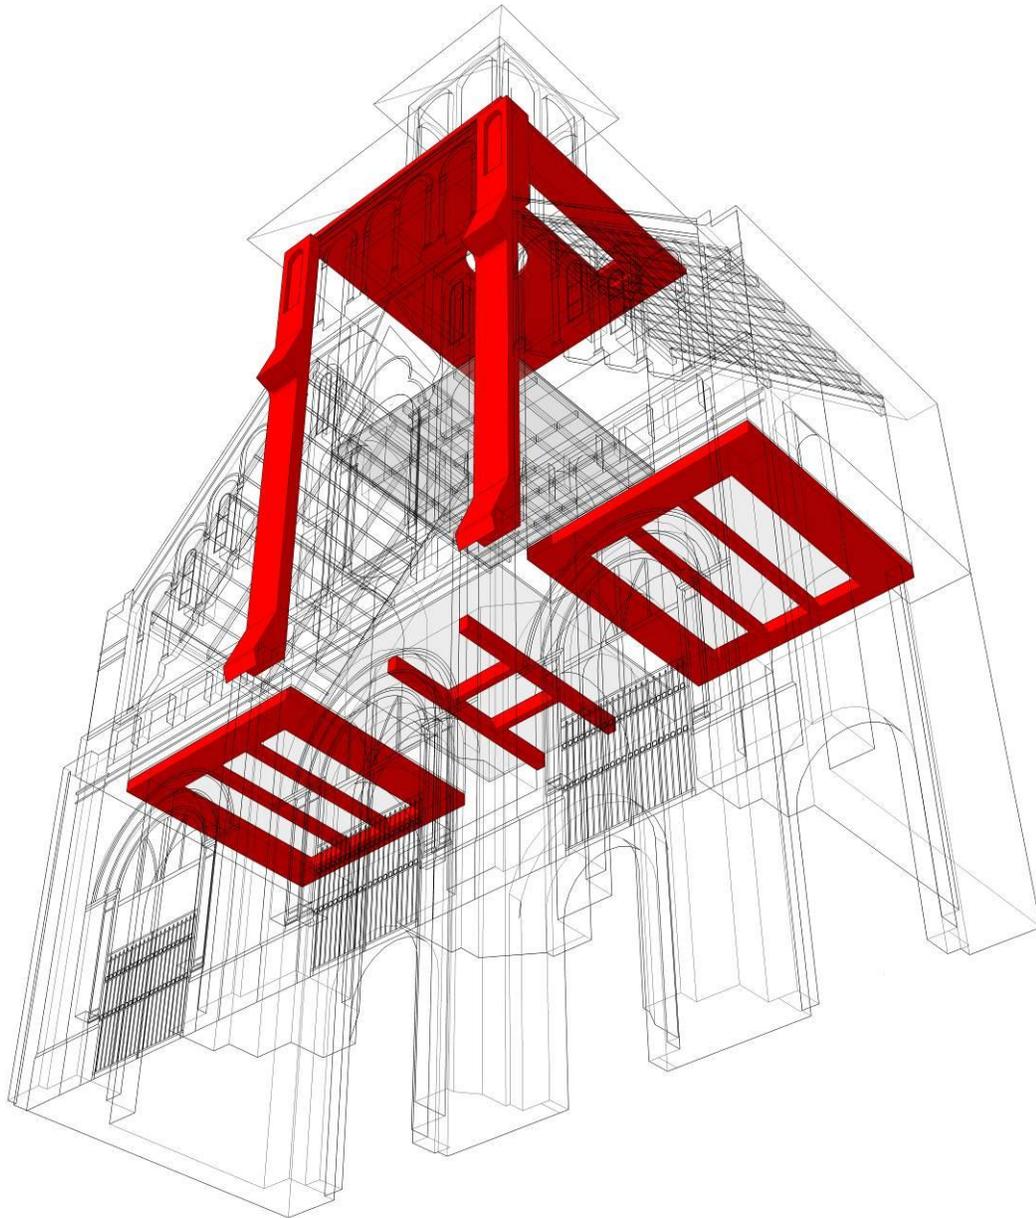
Isométrica de volumen frontal indicando en rojo los refuerzos de hormigón armado identificados. Elab. Propia.
